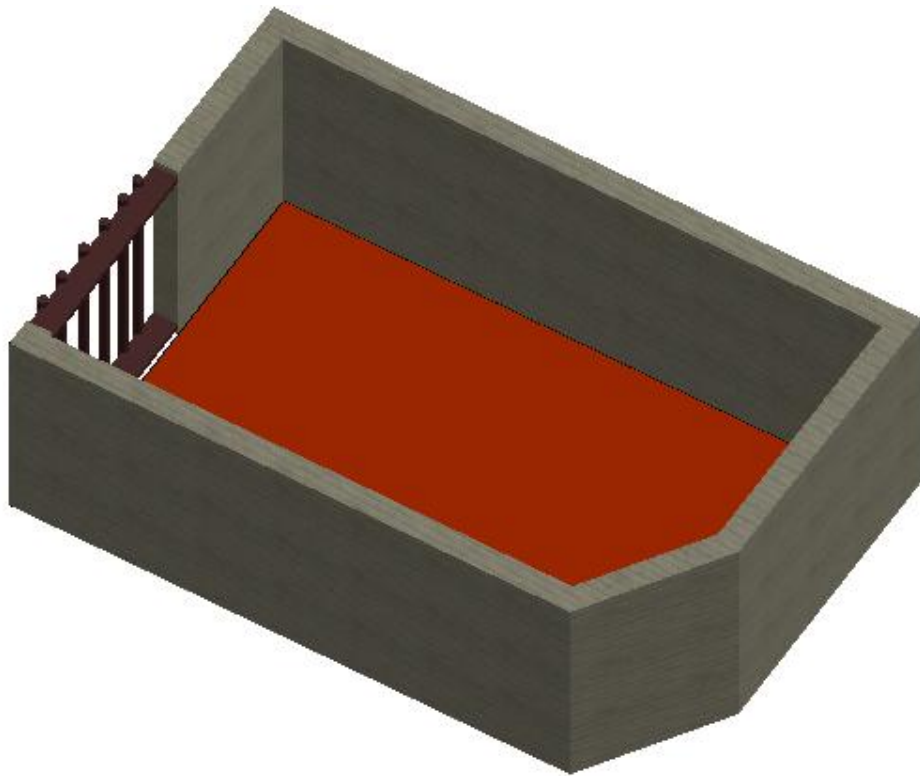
Vista frontal superior de la construcción propuesta para el sistema de bioenergía
